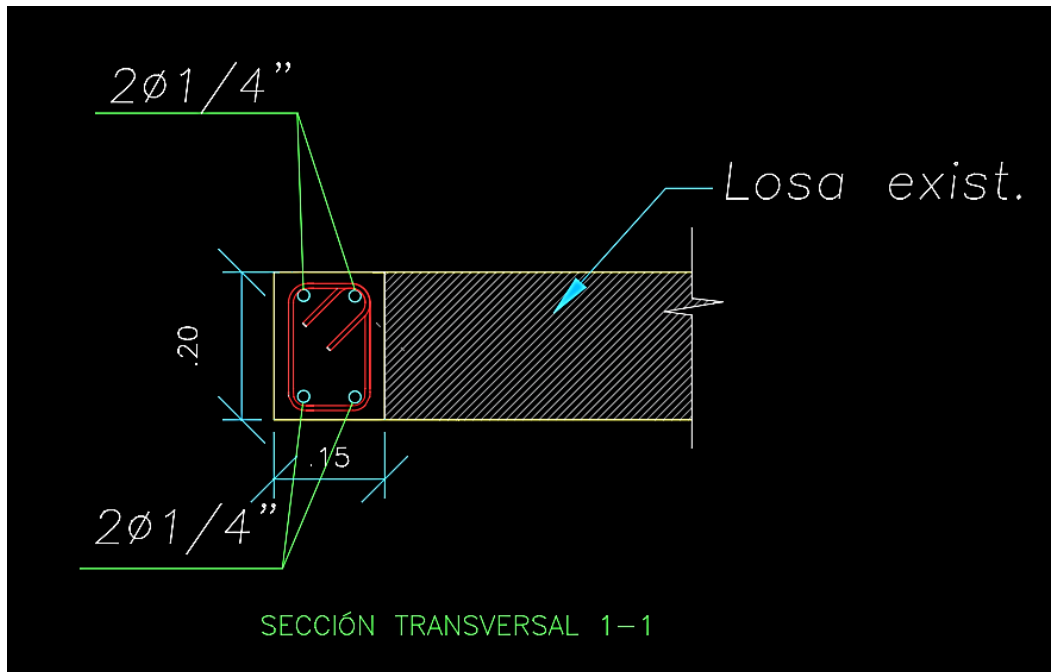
Sección transversal en viga chata 0.15m x0.20 m
